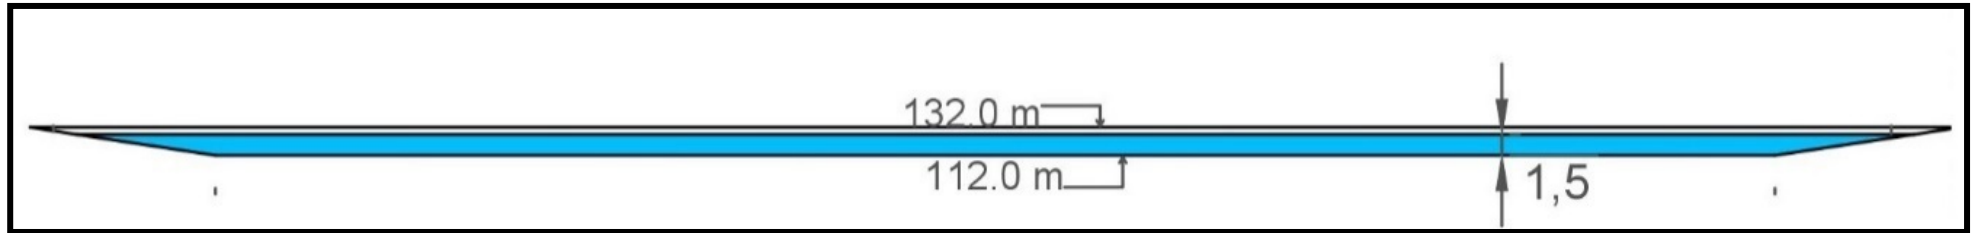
Plano de medidas de la laguna primaria – Corte C-C.
